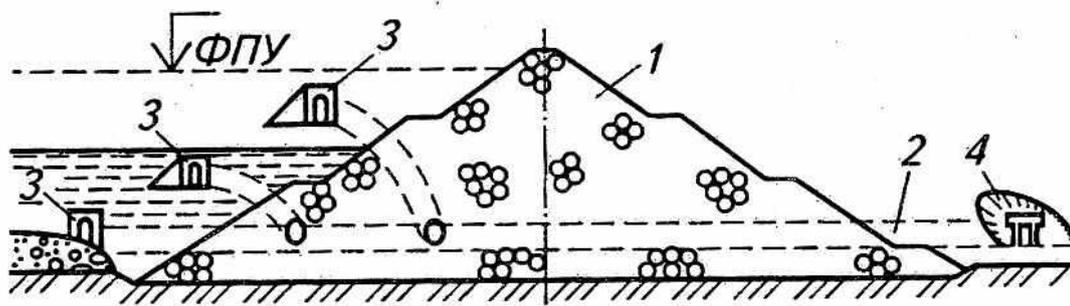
Каменно-набросная плотина и водосброс гидроузла селеохранилища:
